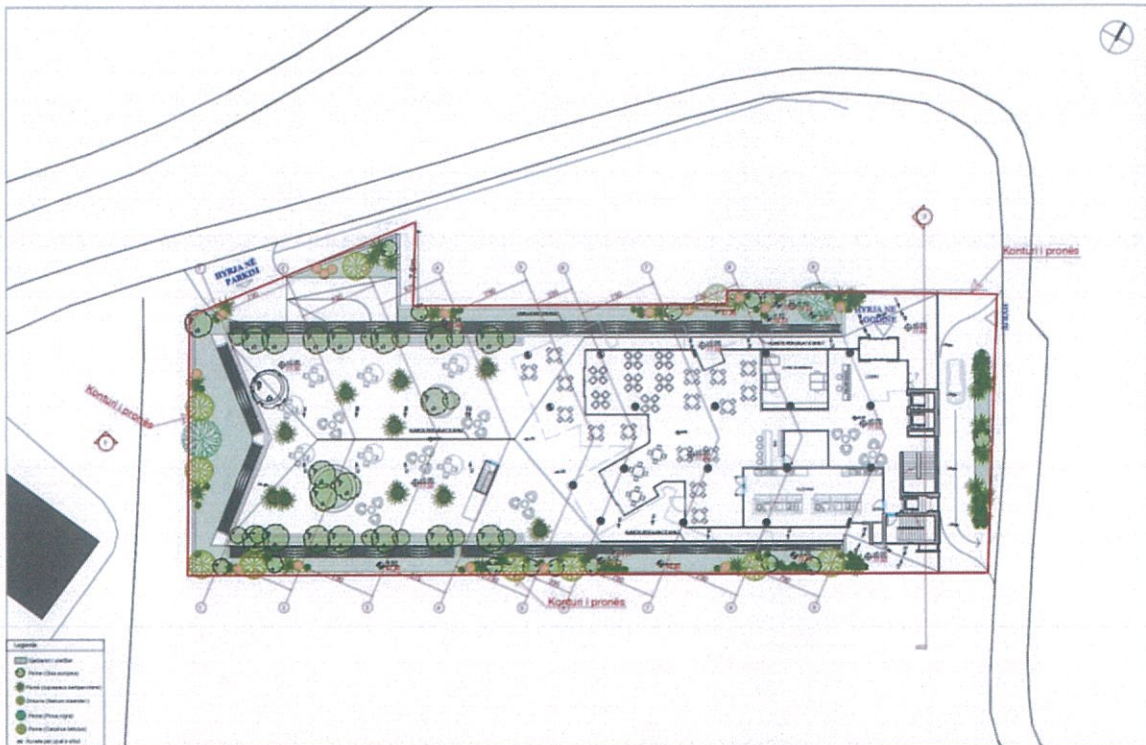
Plani i sistemeve të jashtme të objektit të propozuar
